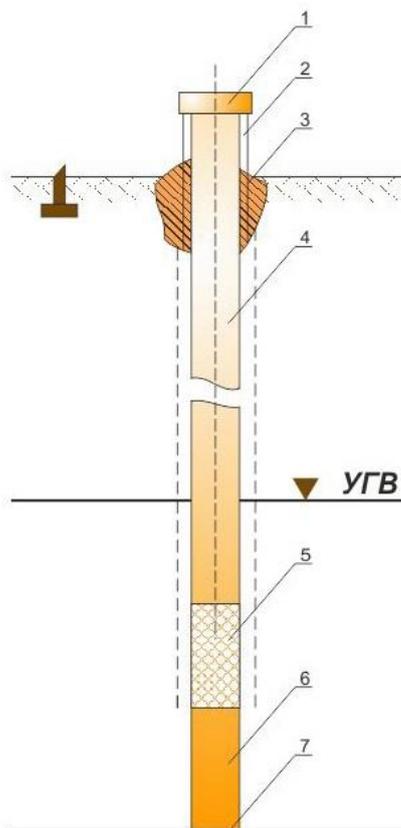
Конструкция наблюдательной скважины (1 – оголовок; 2 – трубы; 3 – цементный замок; 4 – фильтровая колонна; 5 – фильтр; 6 – отстойник; 7 – пробка).
